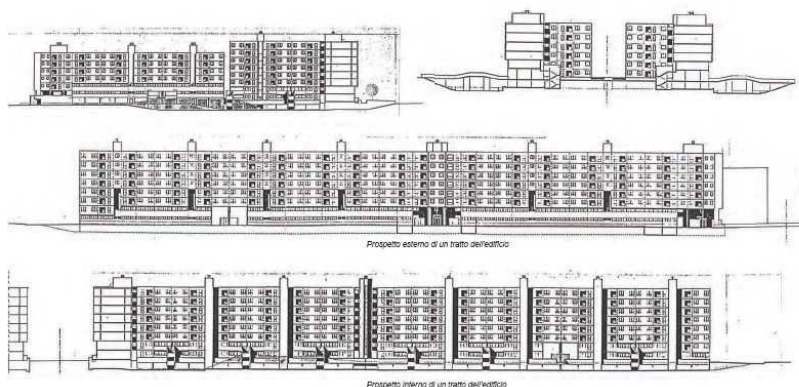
Prospetti dell'edificio progettato da Pietro Barucci per Tor Bell Monaca
